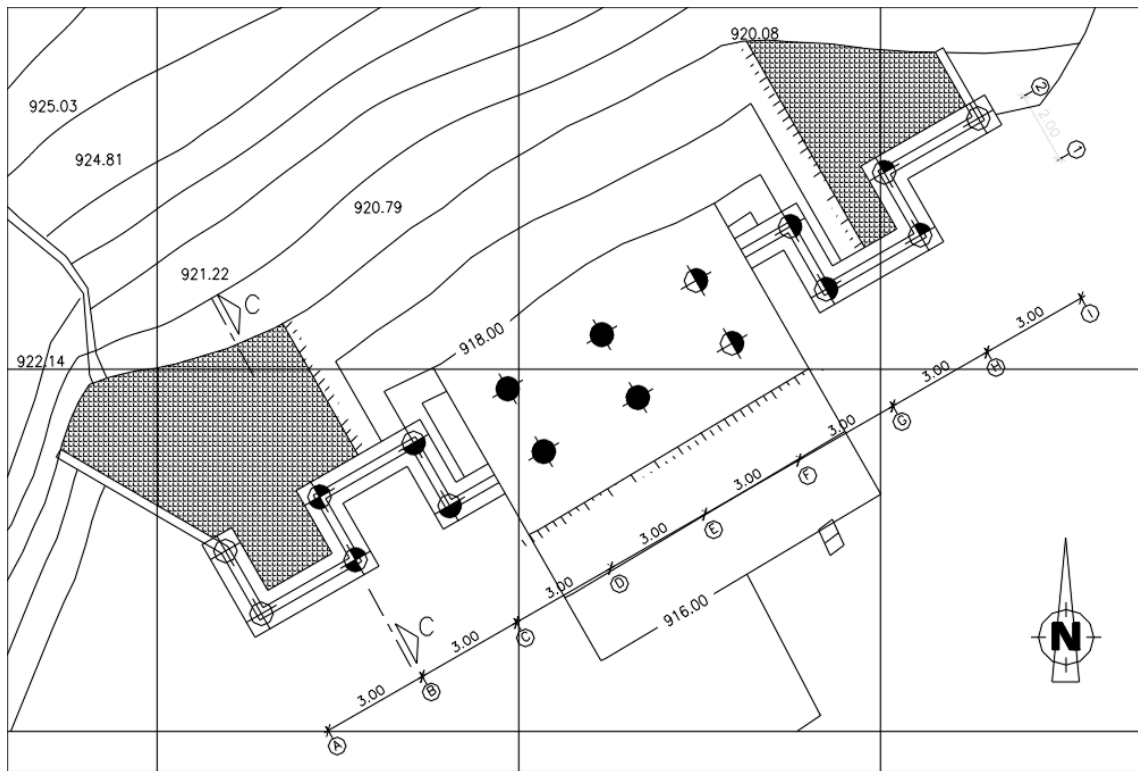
Etapa intermedia de construcción del muro desde los extremos hacia el centro.
